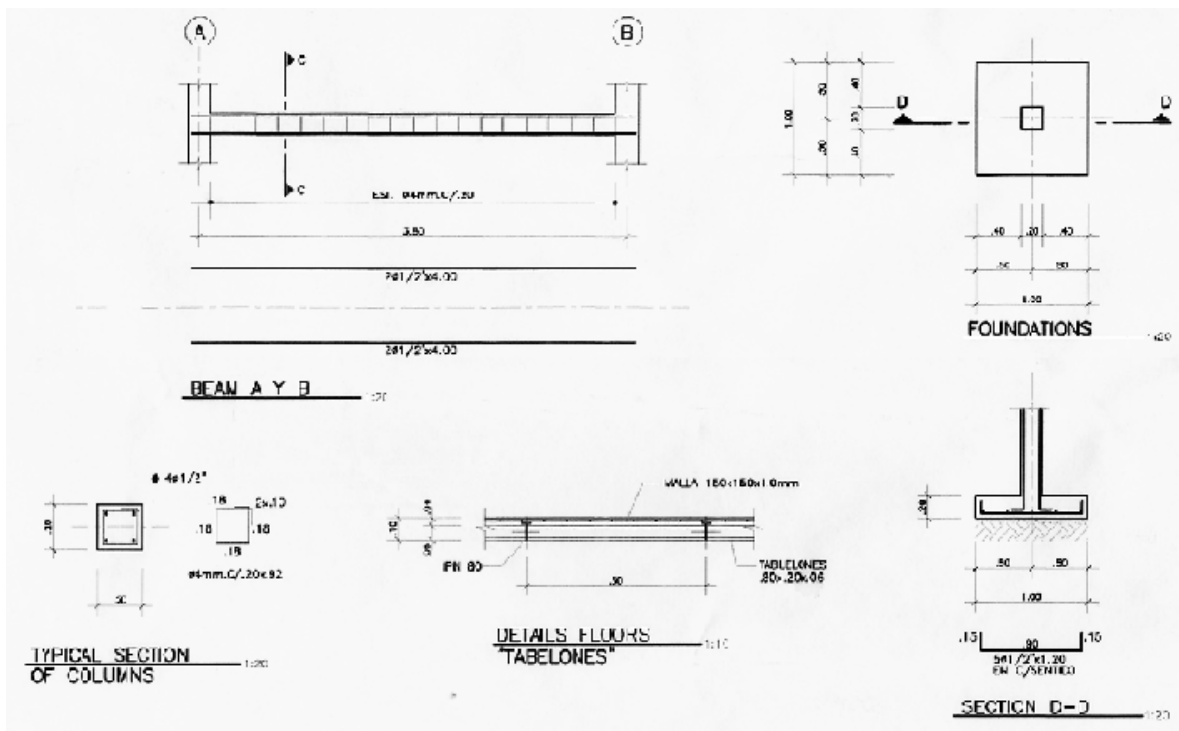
Detalle del Piso y Fundación de los Modelos
